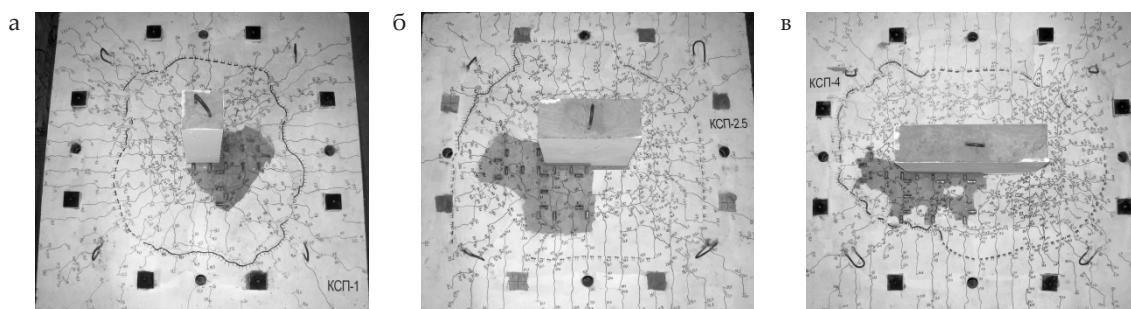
Опытные образцы после испытаний (вид сверху): а – образец КСП-1; б – образец КСП-2,5; в – образец КСП-4
